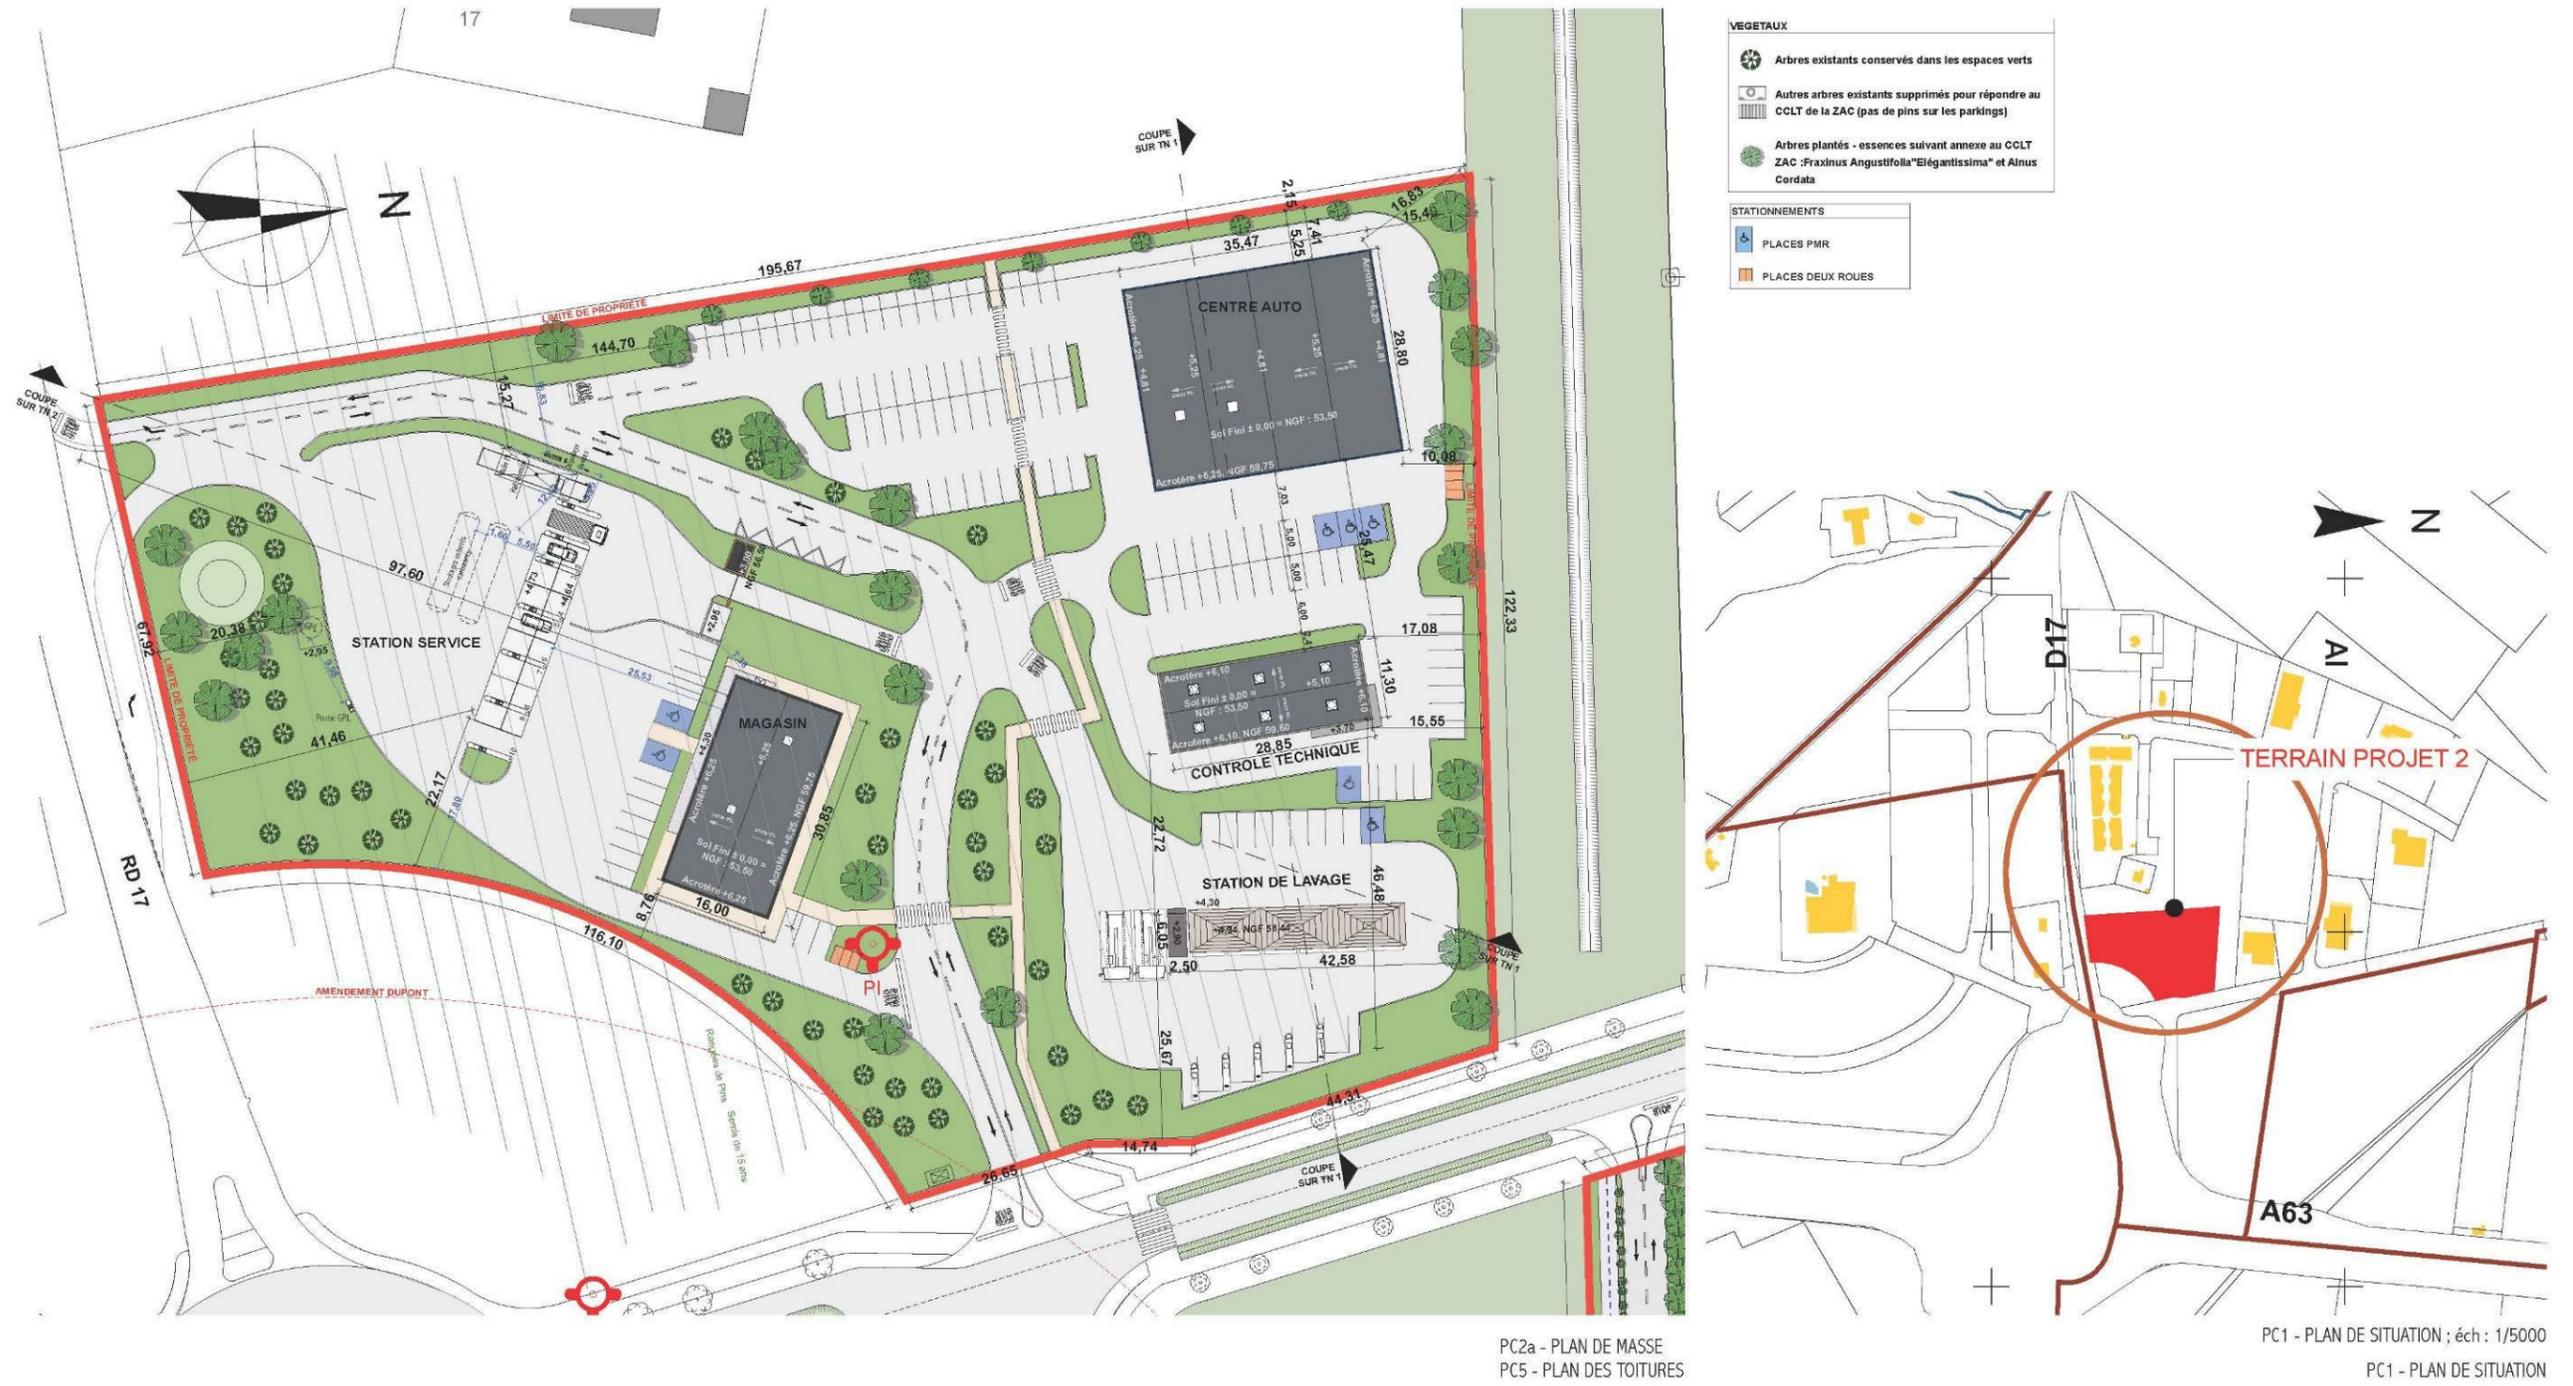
Plan de masse du projet – Unité foncière 2 (source Atelier d'Architecture Joris Ducastaing)
